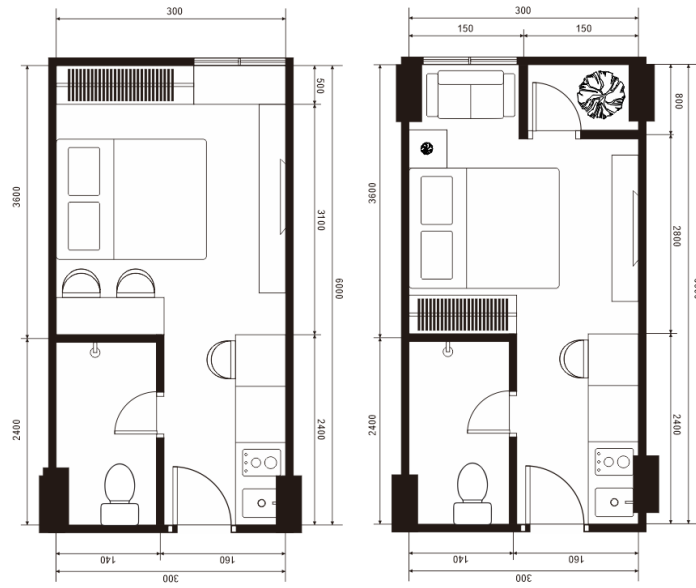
14 Berbagai macam layout apartemen tipe studio
